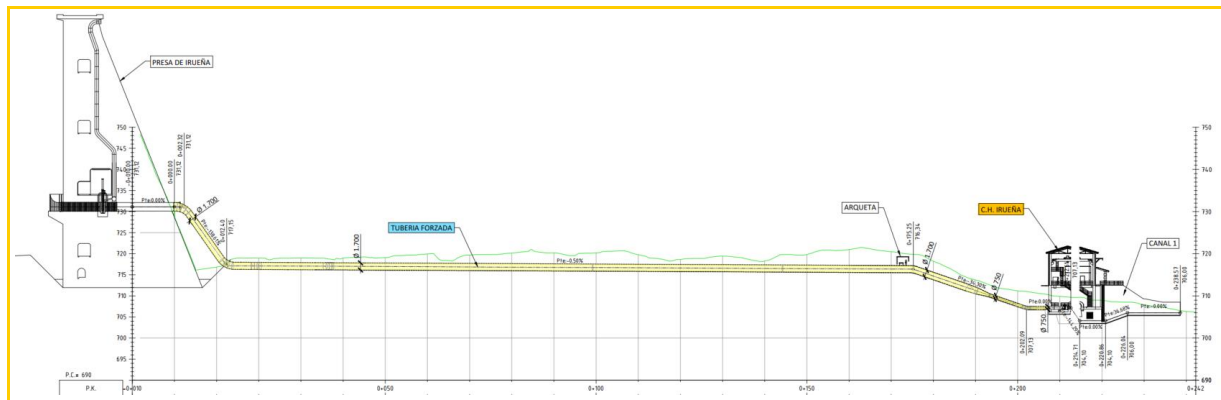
Perfil longitudinal de la Tubería Forzada, color amarillo.
